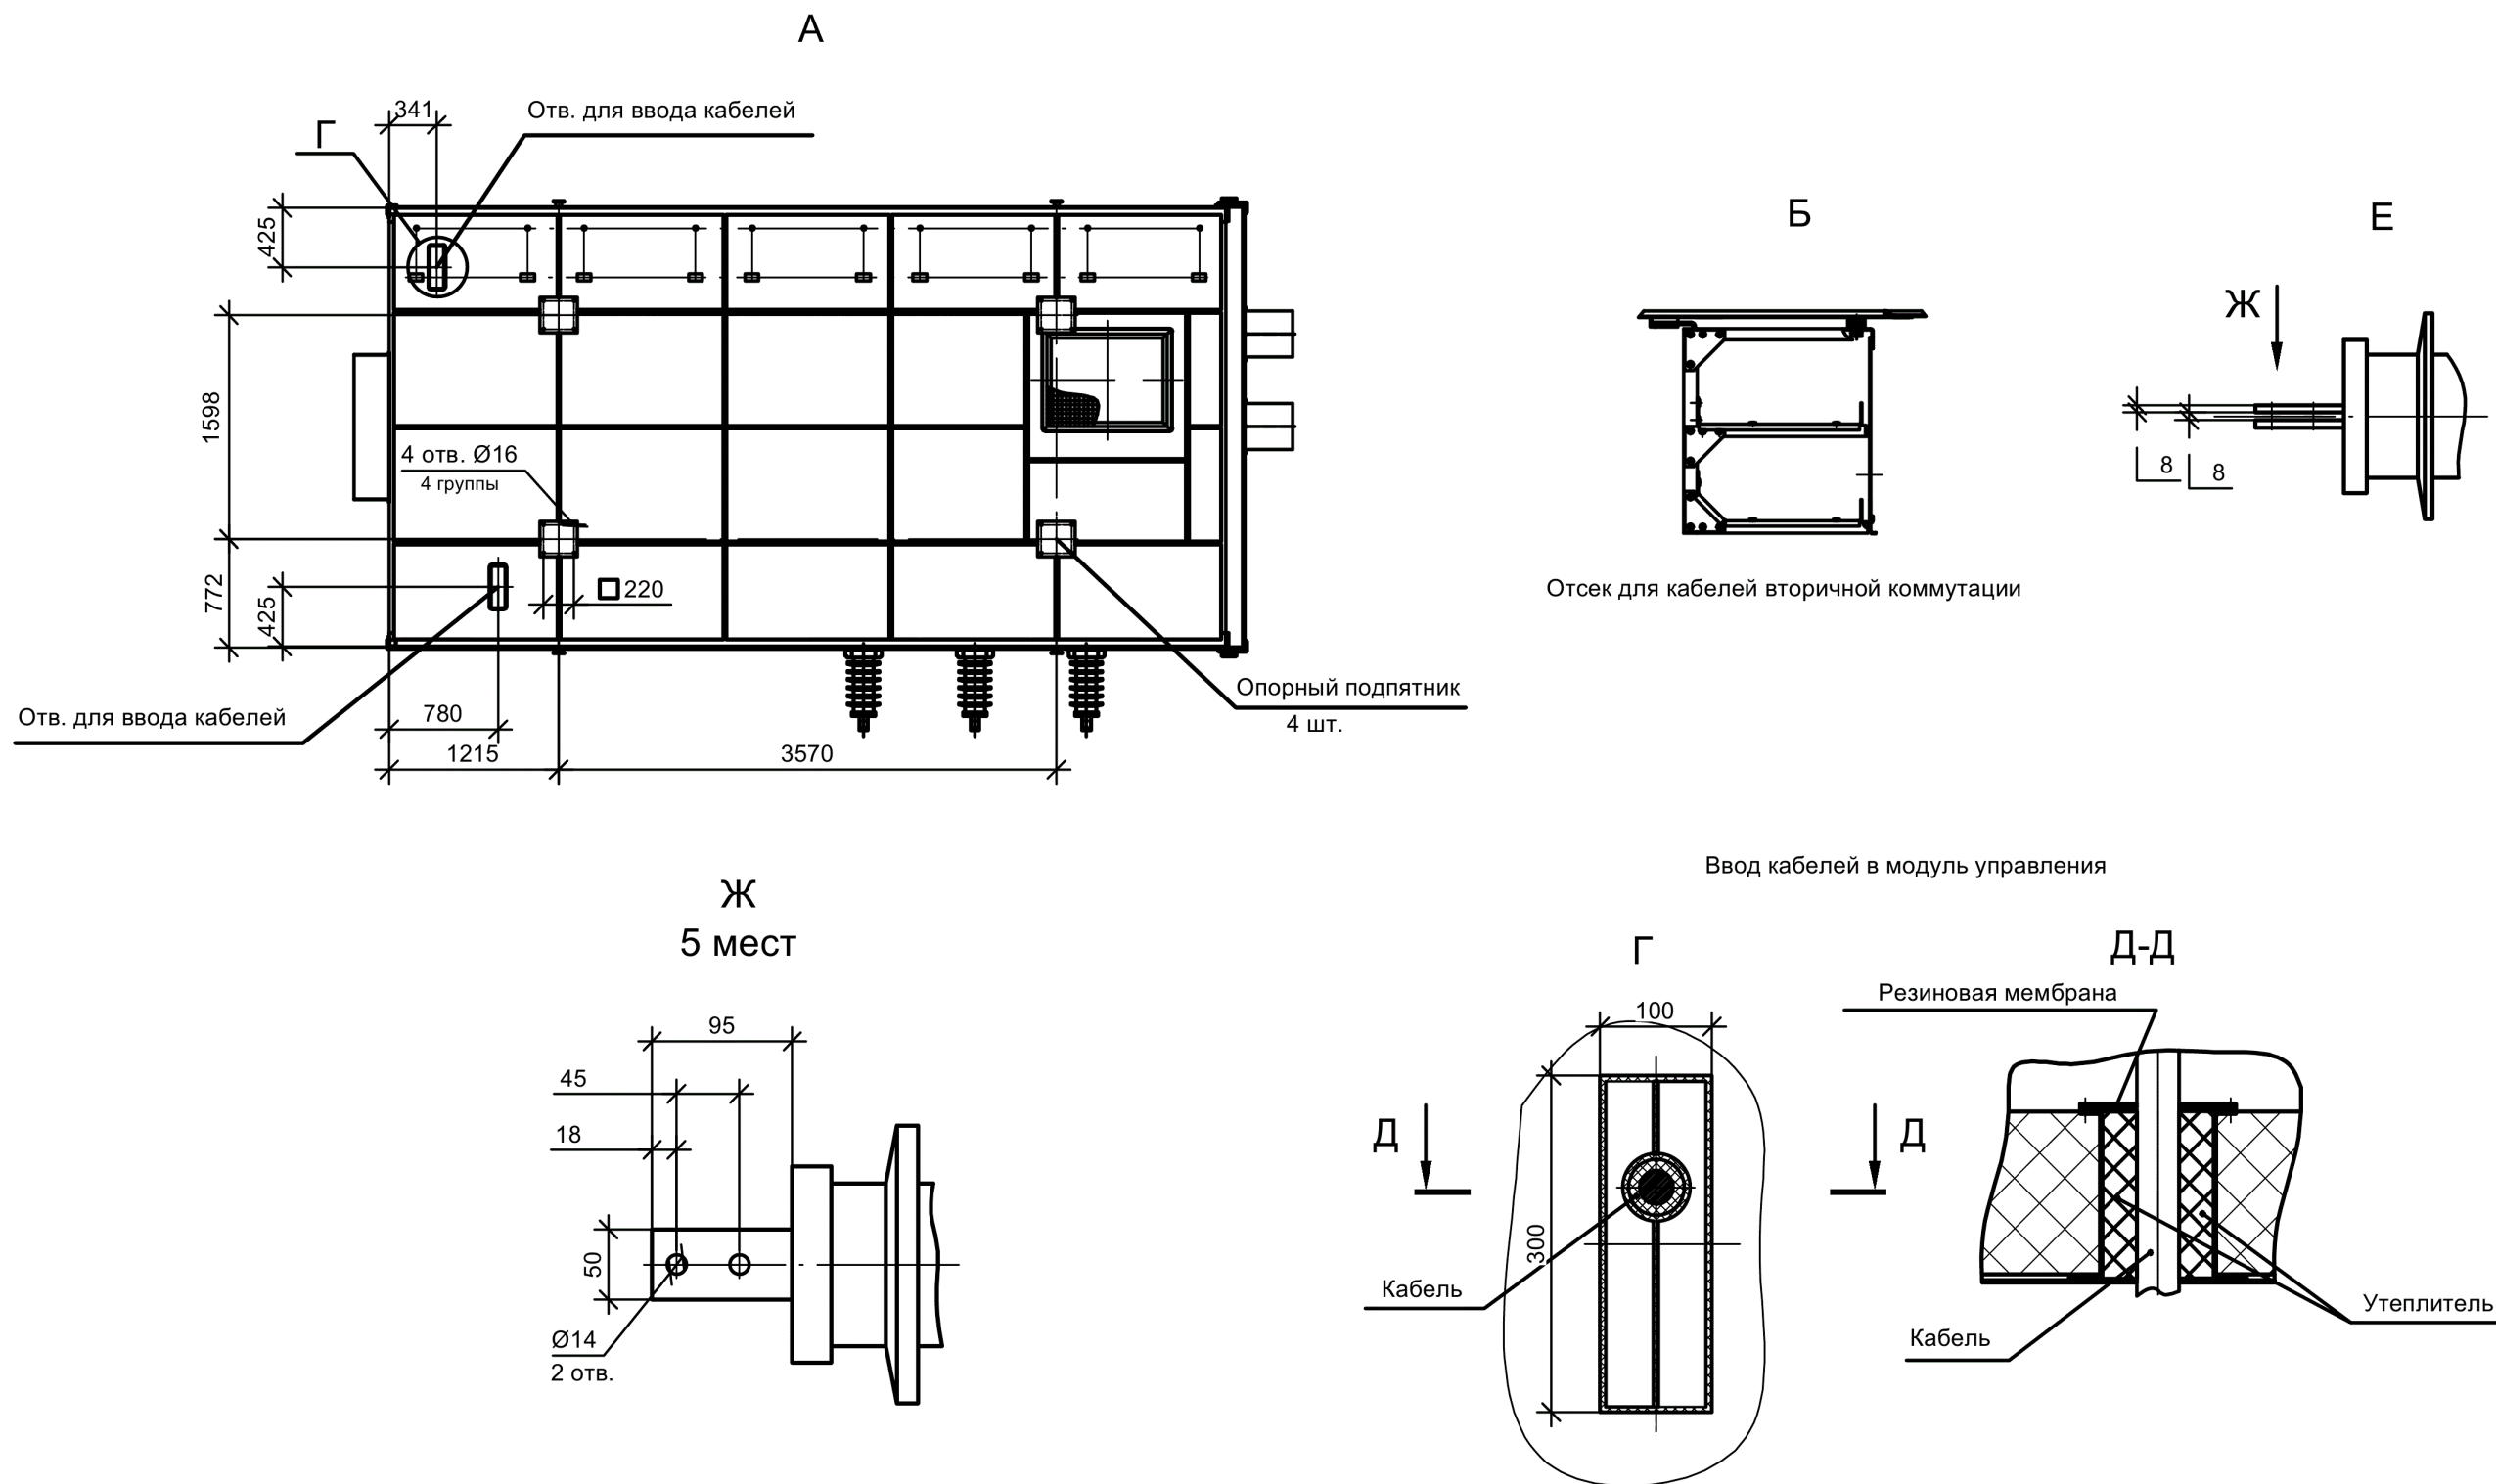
Габаритный чертеж модуля управления УПК
